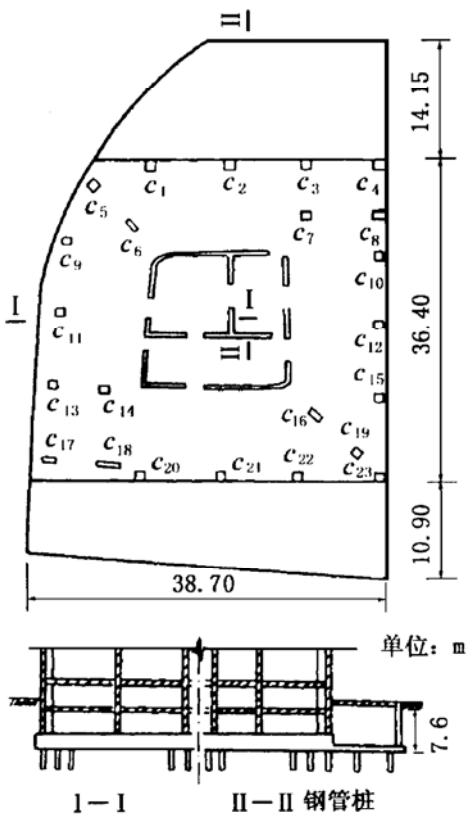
上海富豪外贸大酒店平面图和地下室剖面图
